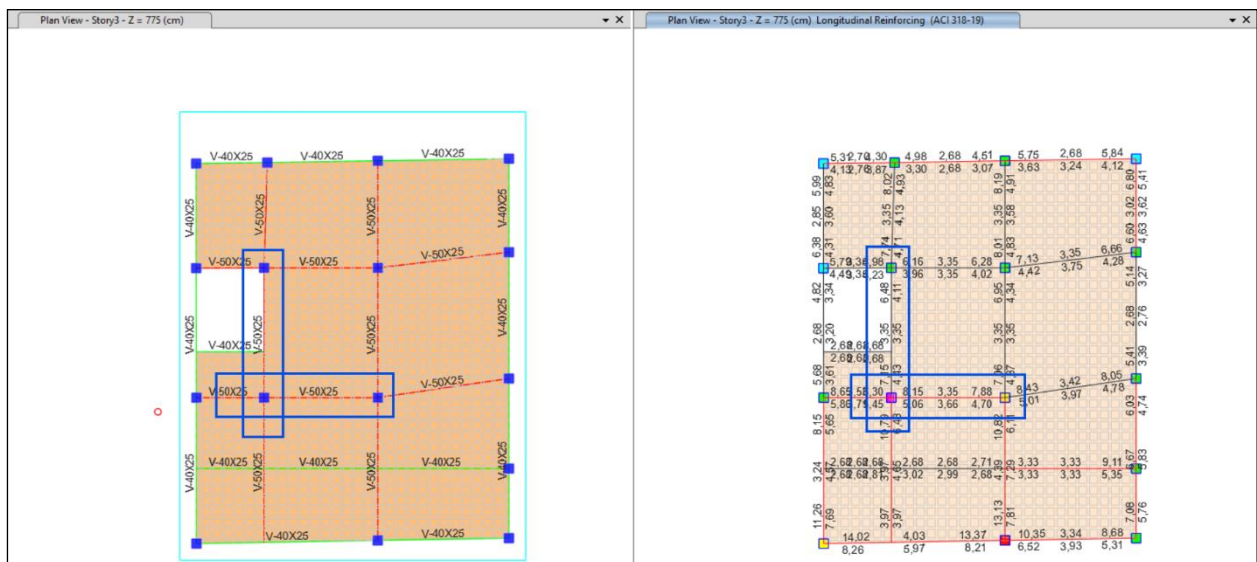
Acero a flexion en vigas de losa nivel 3, alternativa 2 [Autor]
